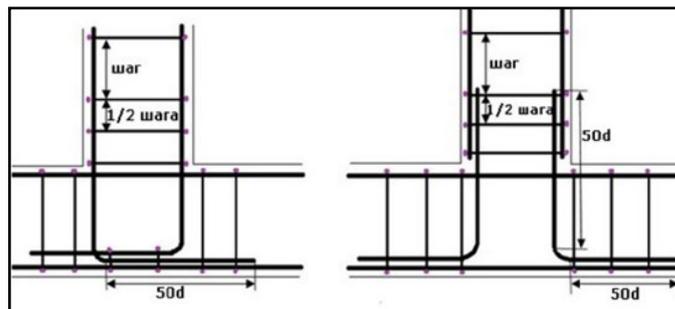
Армирование монолитного пояса в местах пересечения стен
